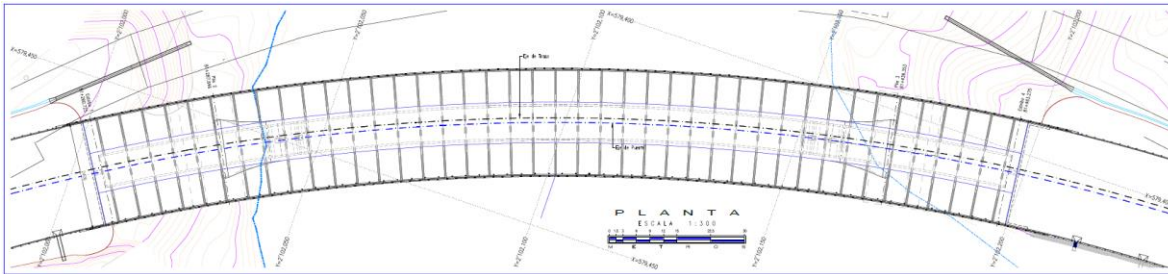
Planta del Nuevo Puente Tepalcates II. Ver Anexo II.4 Plano General de Proyecto
